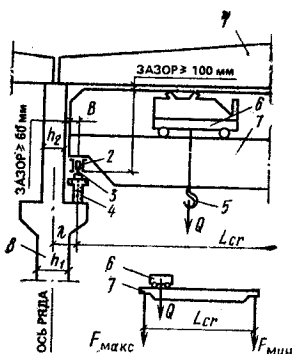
Схема мостового крана и тележки с крюком на гибкой подвеске
